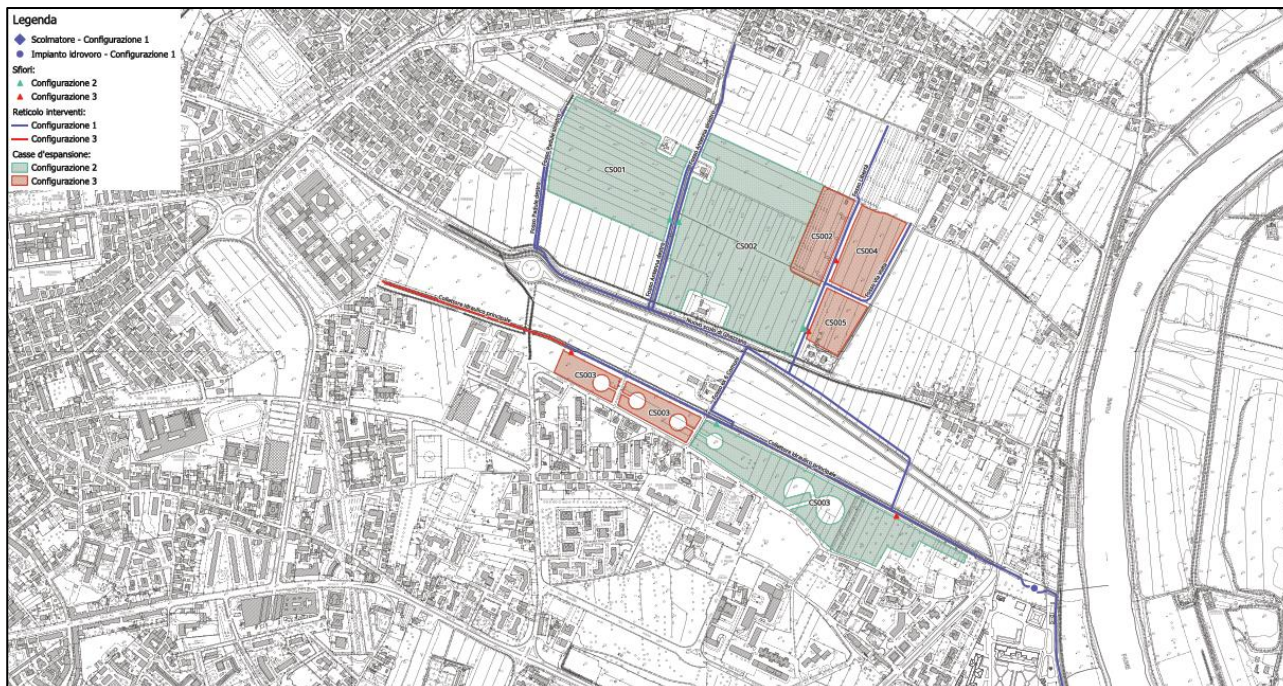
Estratto Tav. T.02- Planimetria interventi. In rosso quanto ulteriormente previsto dalla configurazione 3
